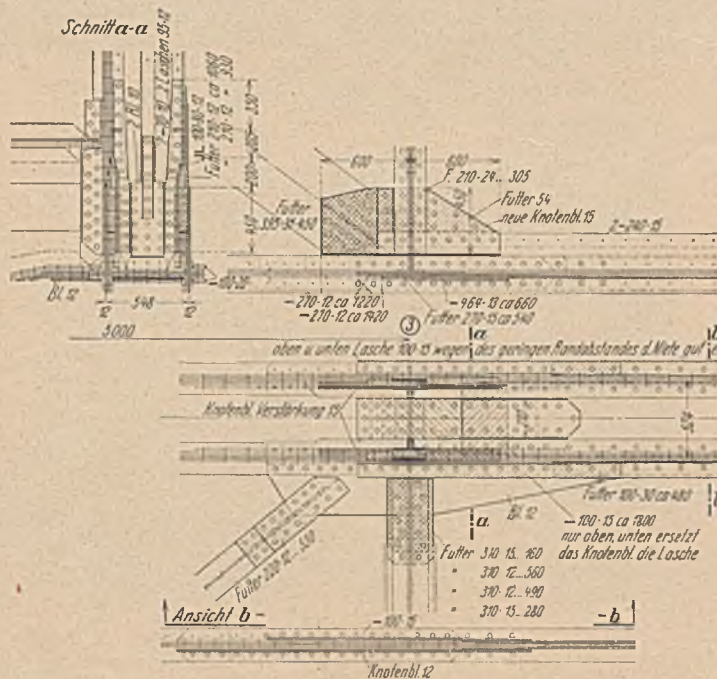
Kahnfahrtbrücke, Knotenpunkt 3.
